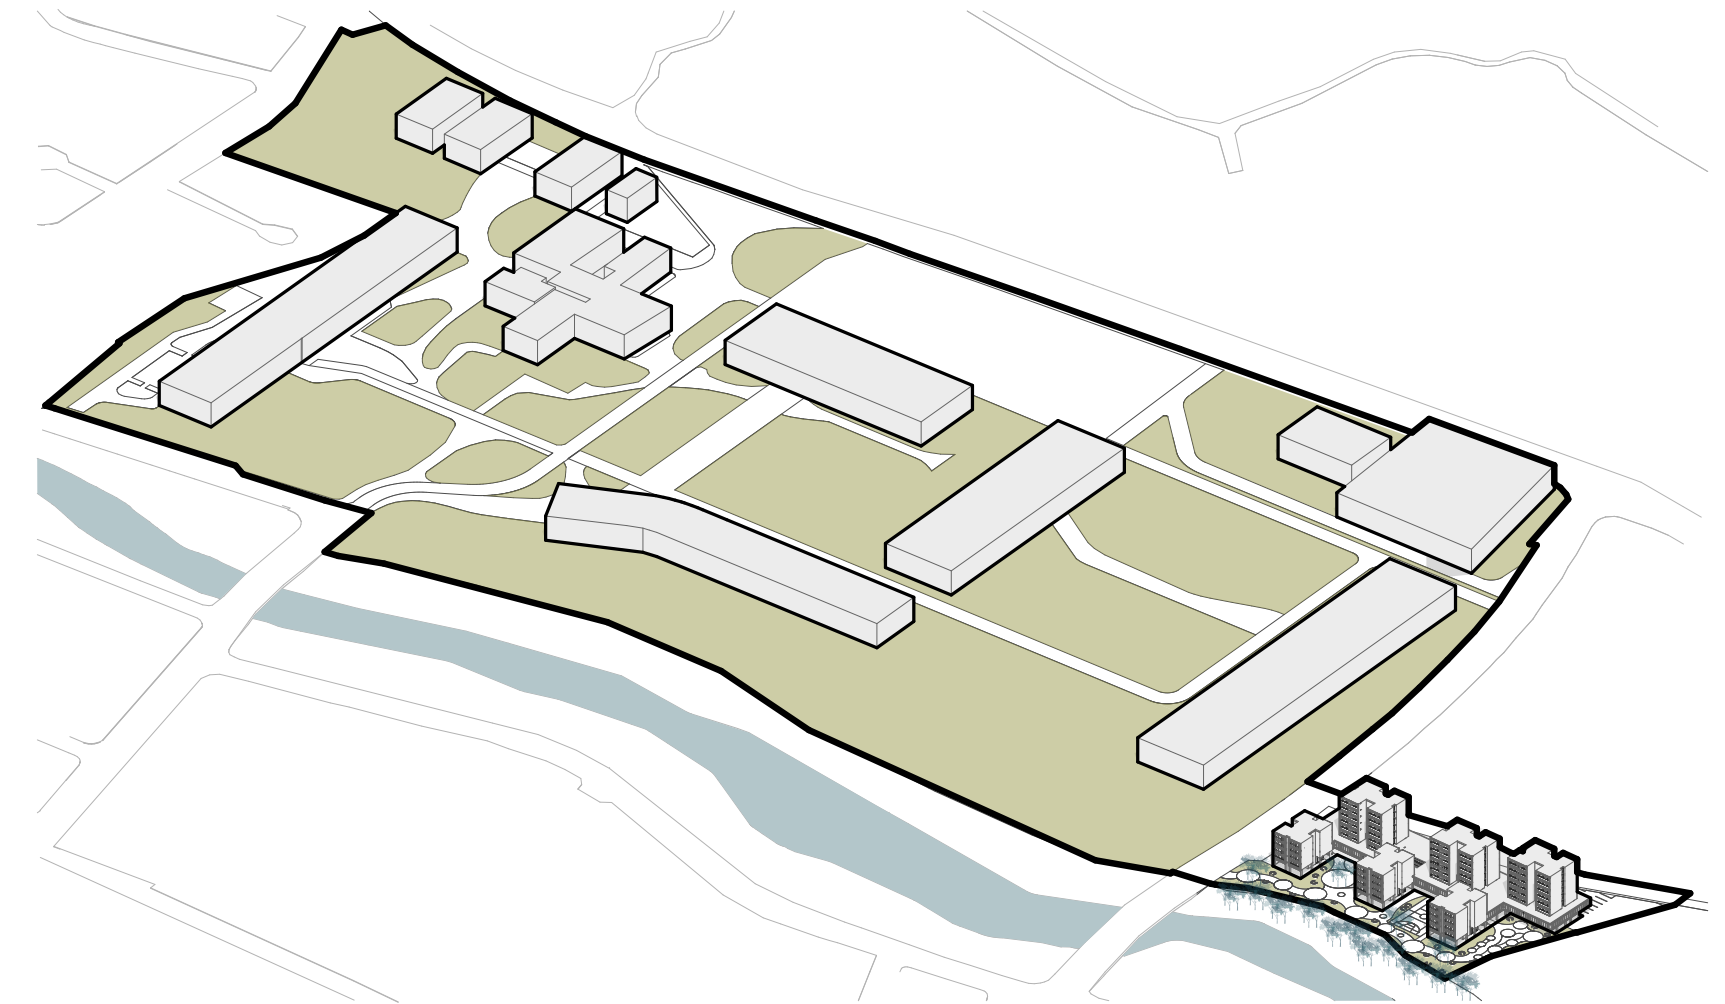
Anteproyecto Arquitectónico Fuente Autoría Propia
